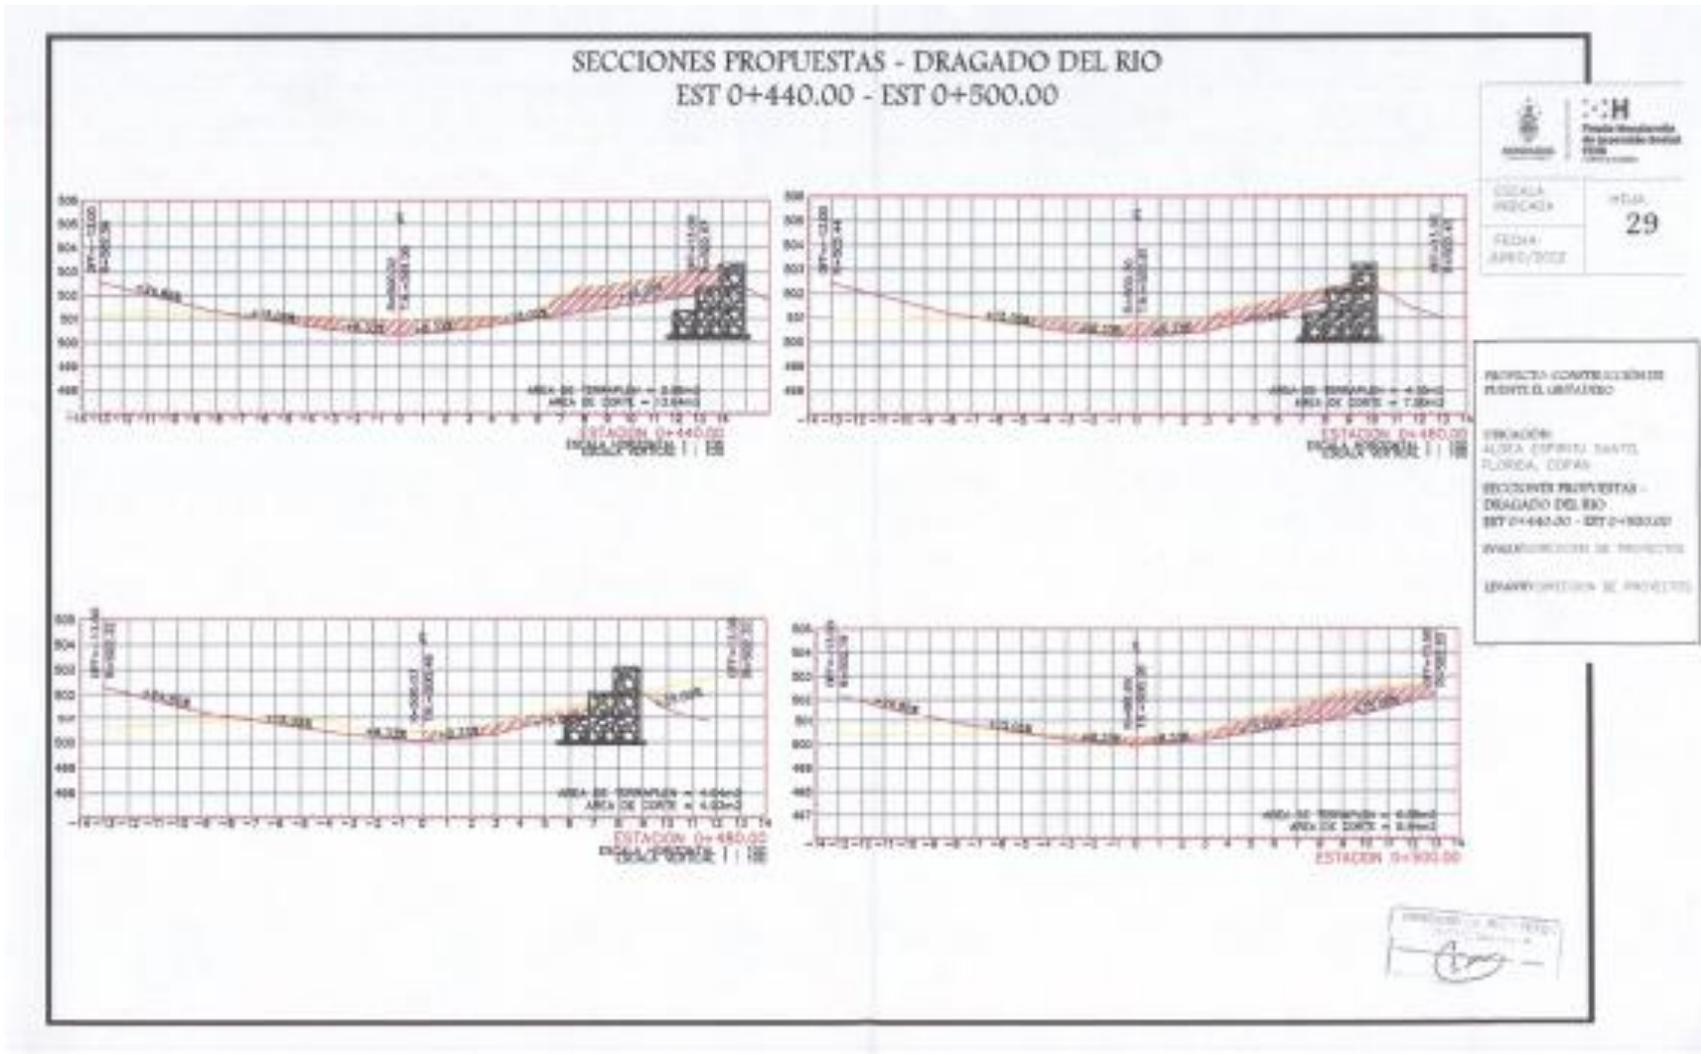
Secciones propuestas para dragado de río 0+440- 0+500
